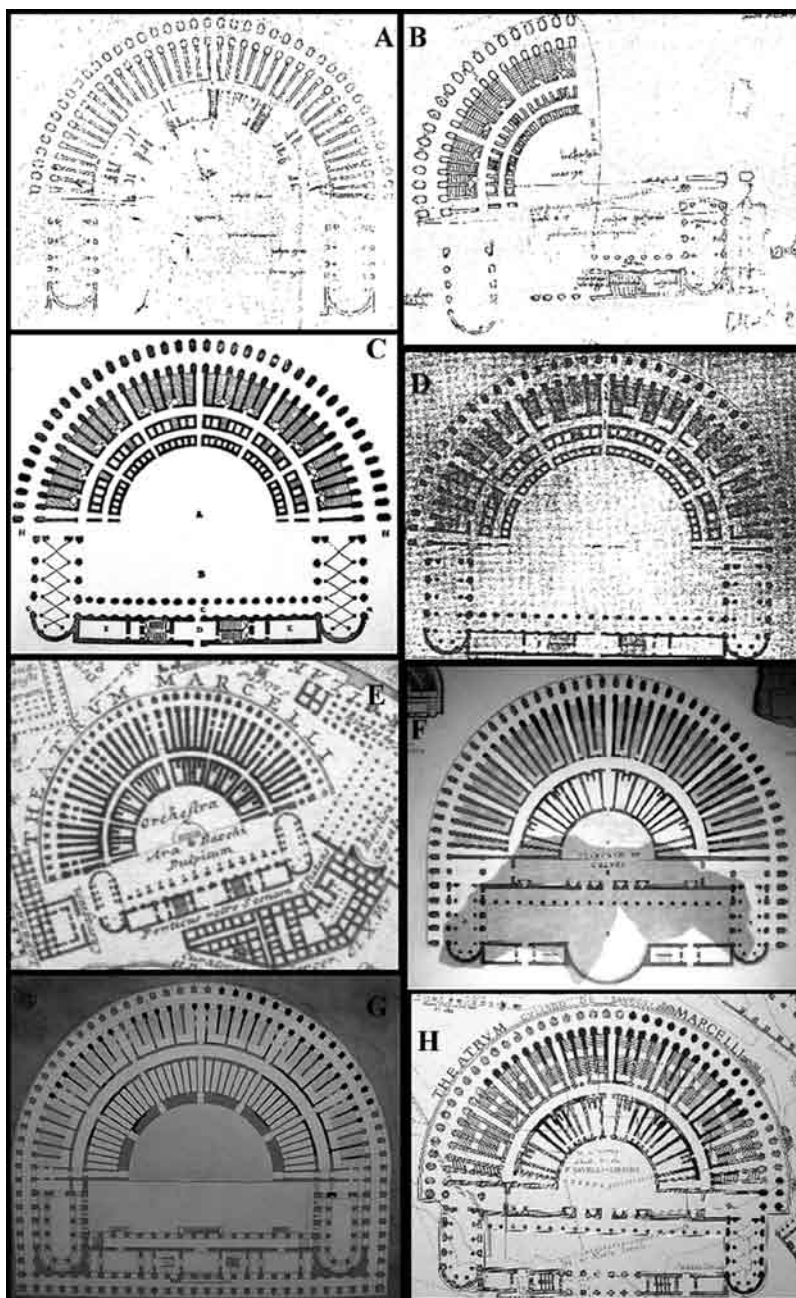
a.- Planta del Teatro de Marcelo de G.B y A. Da Sangallo; b.- Planta de G.B. Da Sangallo; c.- Planta de S. Serlio; d.- Planta de A. Desgodetz; e.- Planta de G. B. Piranesi; f. Planta de L. Canina; g.- Planta de L. Vandouyer; h.- Planta de R. Lanciani.
